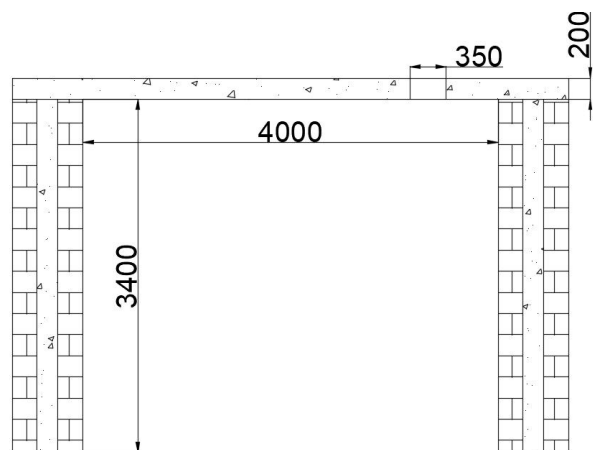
(b) 1-1 剖面布置图 (单位: mm)
